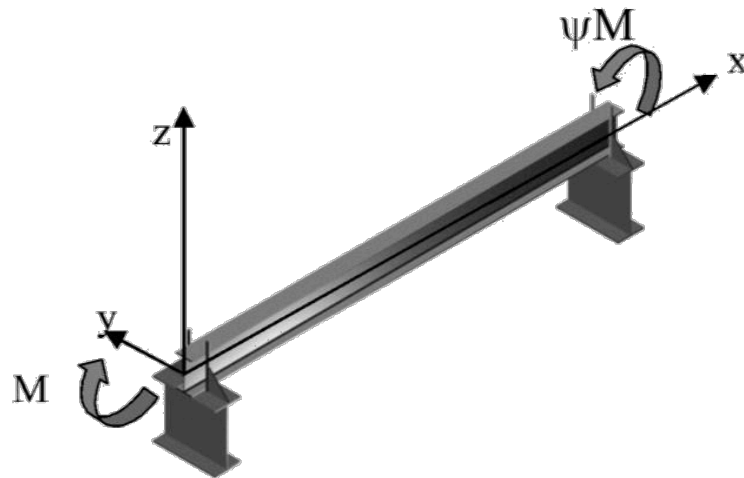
Viga com alma plana simplesmente apoiada (Vila Real, 2003)
